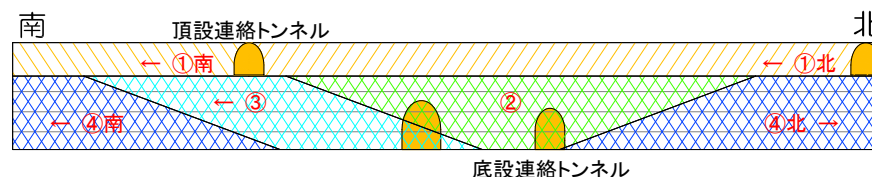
掘削ブロック順序概要 (No.3 貯槽縦断面図)
